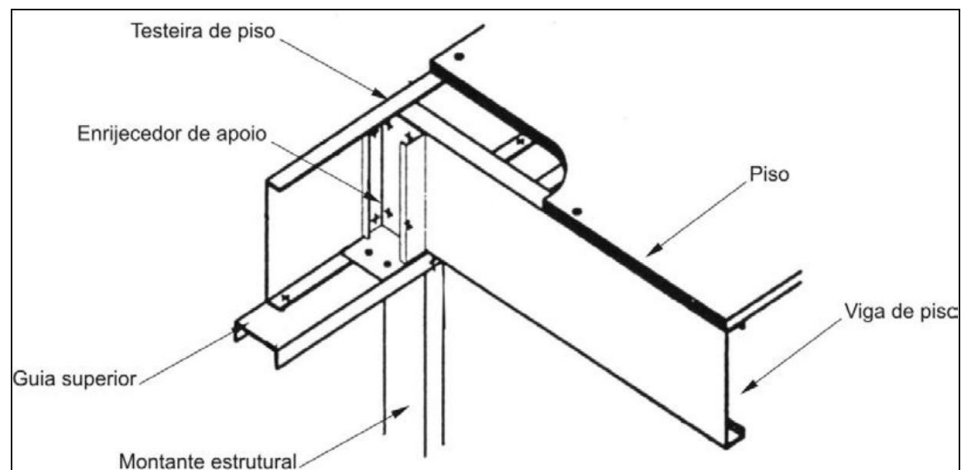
Vigas apoiadas sobre parede lateral. Fonte: Centro Brasileiro em Construção em Aço.
